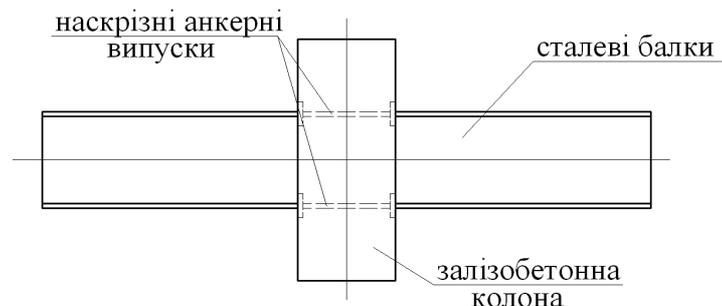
Схема влаштування вузла залізобетонних колон із сталевими балками
